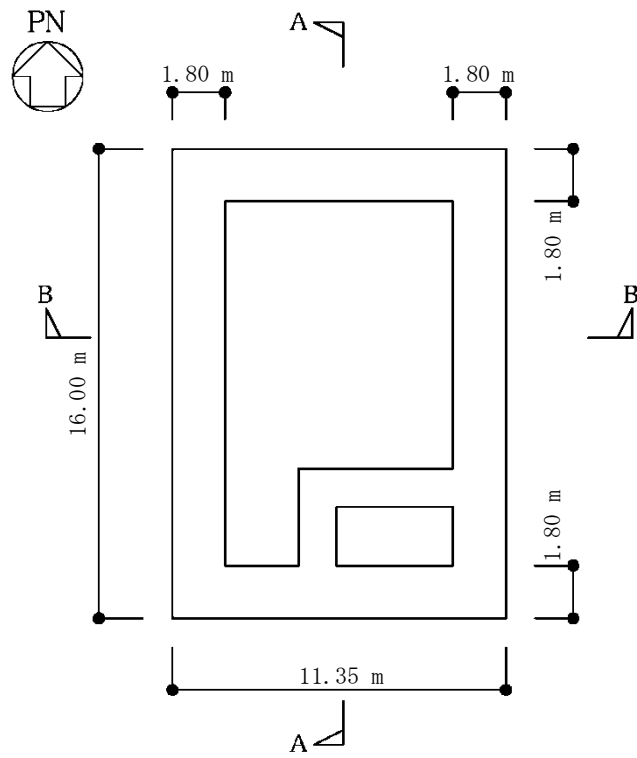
格納槽の概略平面図 (EL. -12.8 m)
